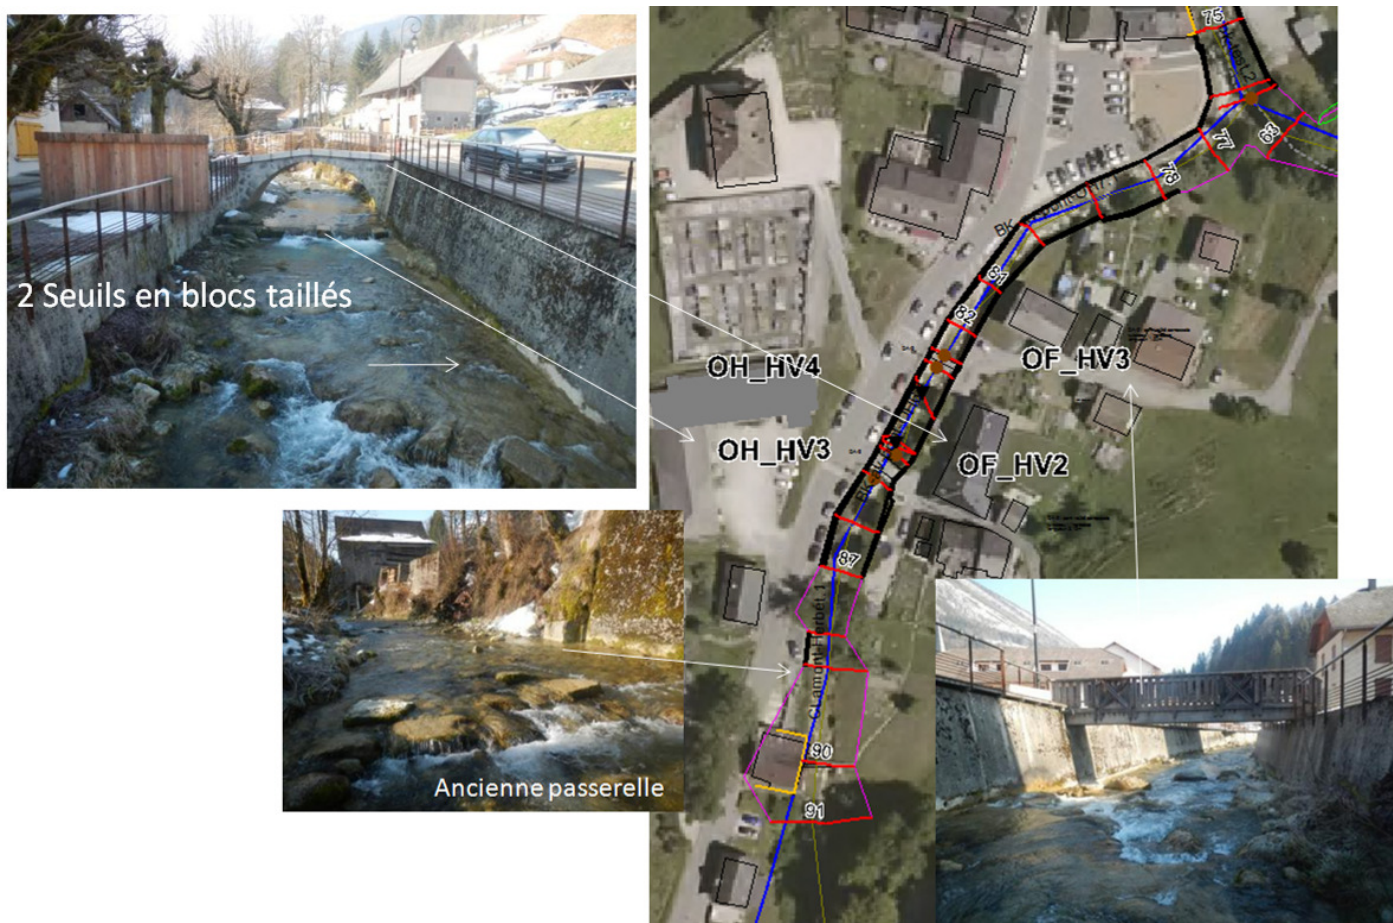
L'Herbetan Vif dans la traversée de Saint Pierre d'Entremont
